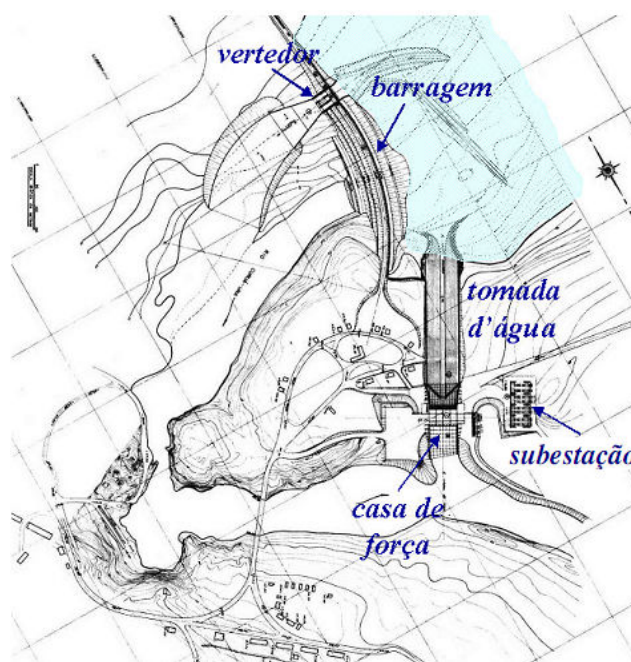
Planta esquemática da UHE de Curuá-Una
